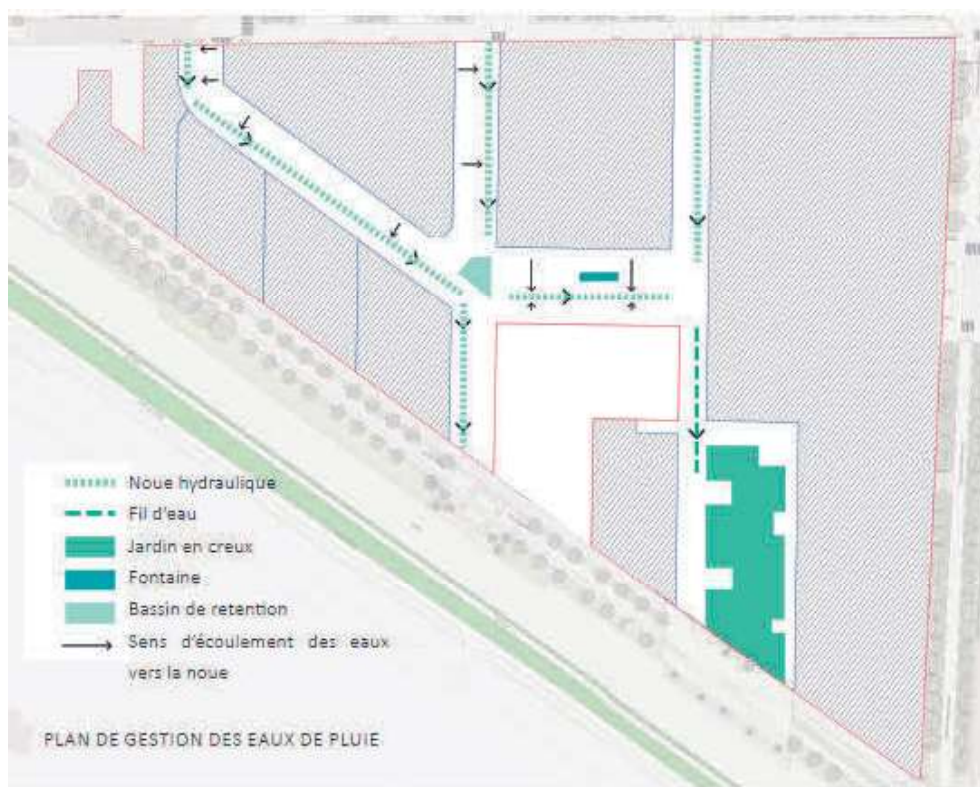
Plan de gestion des eaux de pluie, mai 2021, DDA
